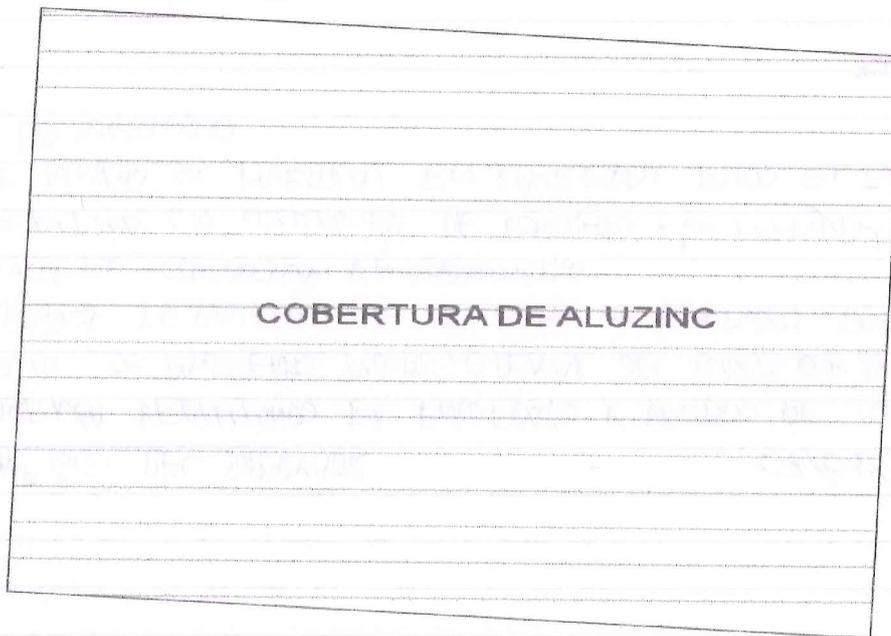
Vista en planta de la I.E. N 81032 en donde se aprecia la proyección de techos con cobertura liviana tipo aluzinc.
